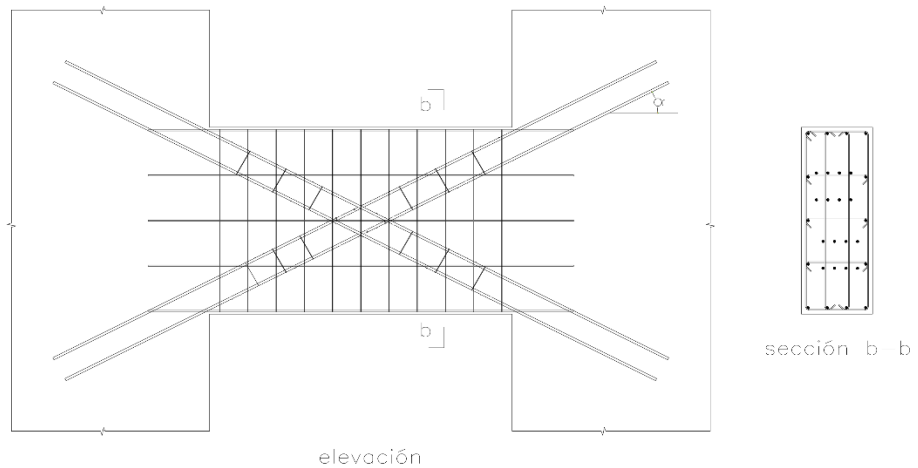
ii Refuerzo alternativo de vigas de acople
